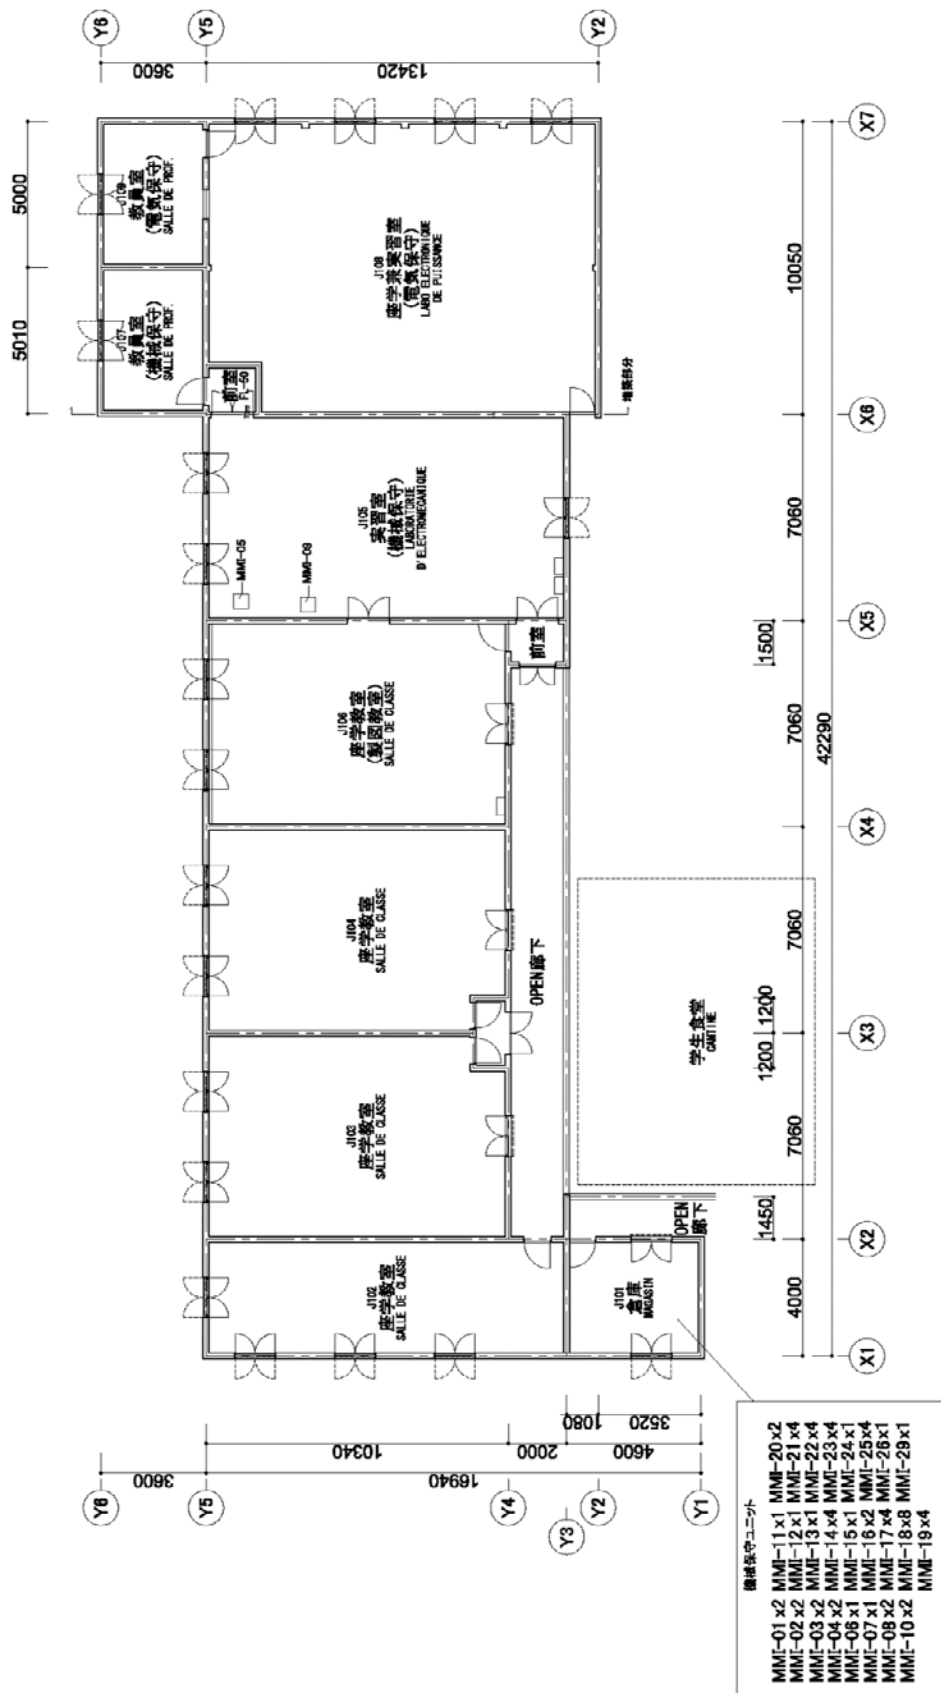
平面図・機材配置図 (J 棟 電気機械科機械保守コース)
